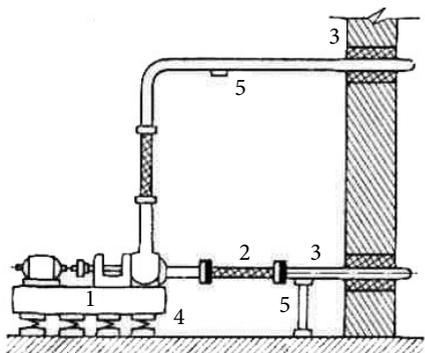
Виброизоляция насосной установки: 1 – железобетонная плита основания; 2 – гибкие вставки; 3 – виброизоляция трубопровода; 4 – виброизоляторы; 5 – стойка с упругой прокладкой.
